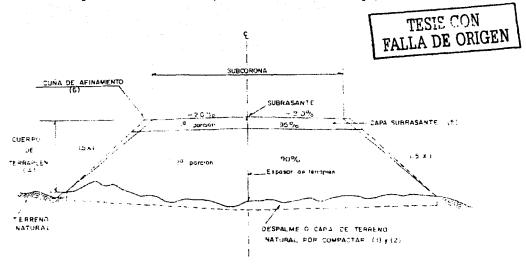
Sección transversal típica conteniendo los elementos del grupo B
